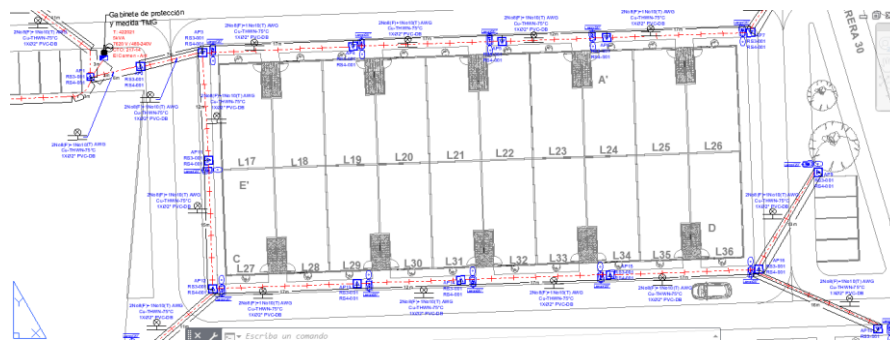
Levantamiento redes eléctricas Brisas del campo.
